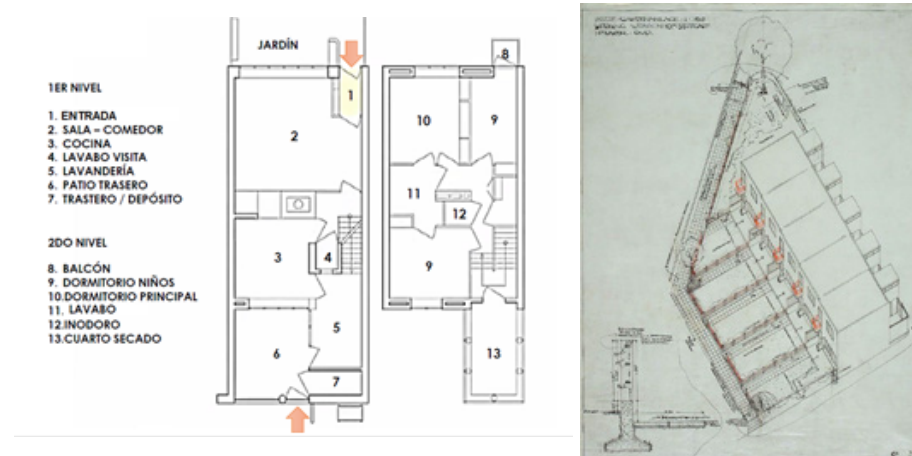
Planta y axonometría de la vivienda de JJ Oud para la colonia Weissenhoff. Alemania. 1927
